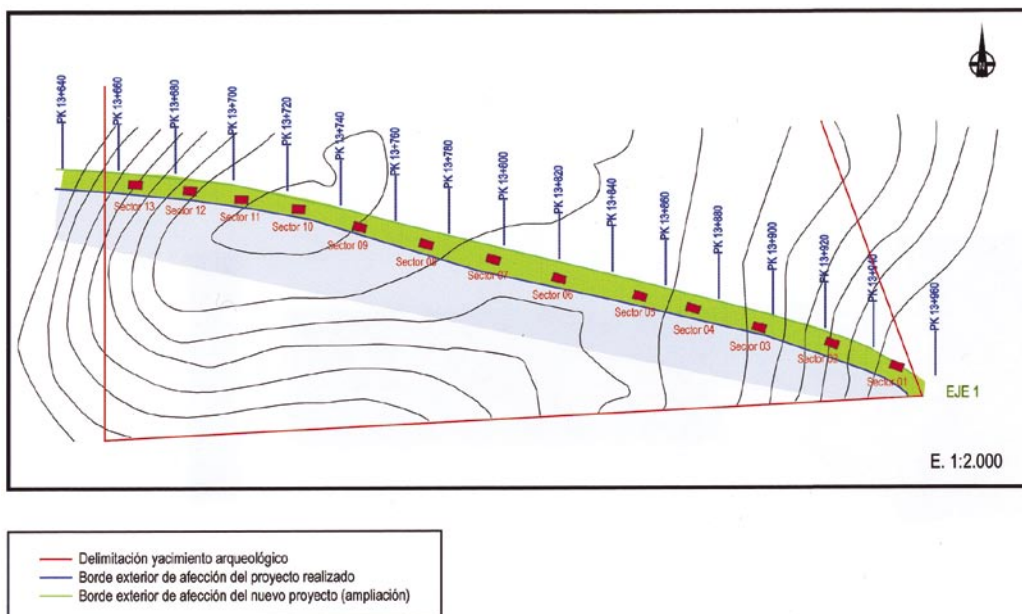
Planimetría General de la Intervención. E. 1:2.000.
